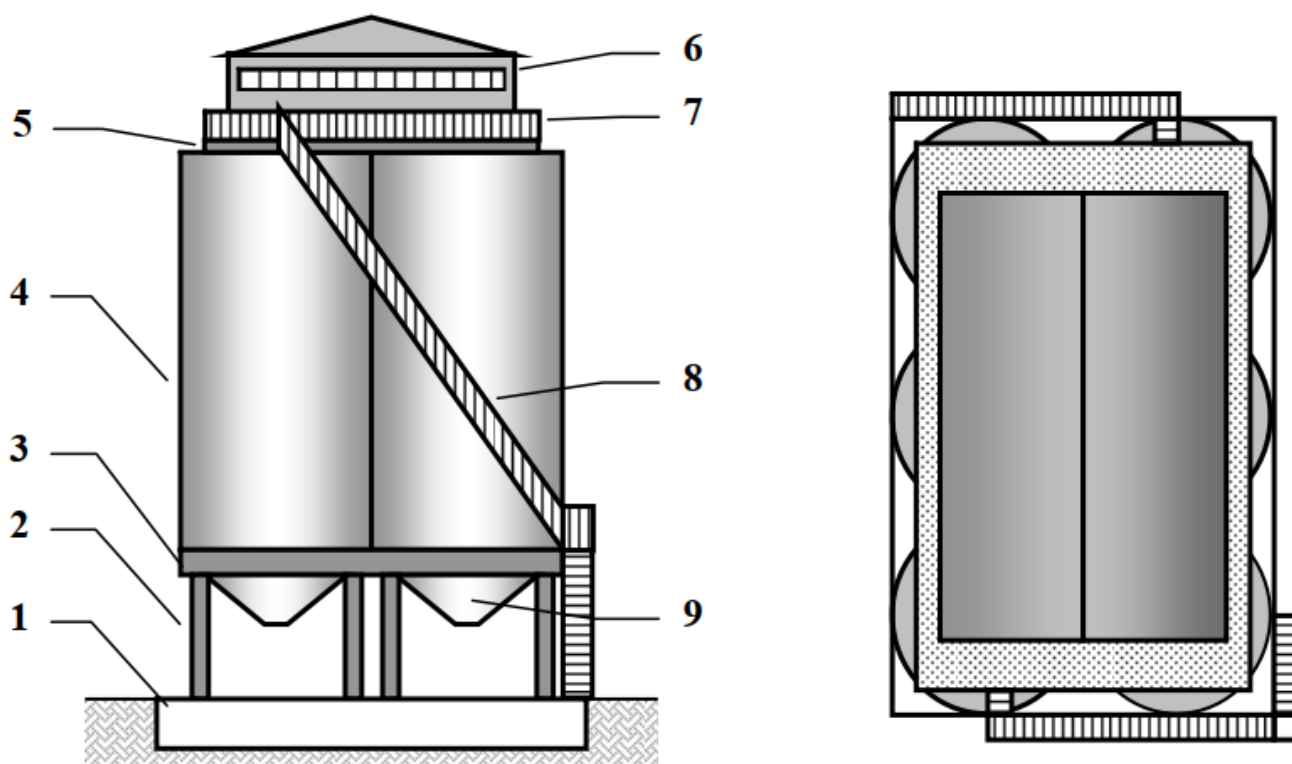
Силосний корпус: 1 – фундаментна плита; 2 – опора; 3 – балка; 4 – силосна банка; 5 – перекриття; 6 – надсилосна галерея; 7 – огороження; 8 – сходи; 9 – воронка
